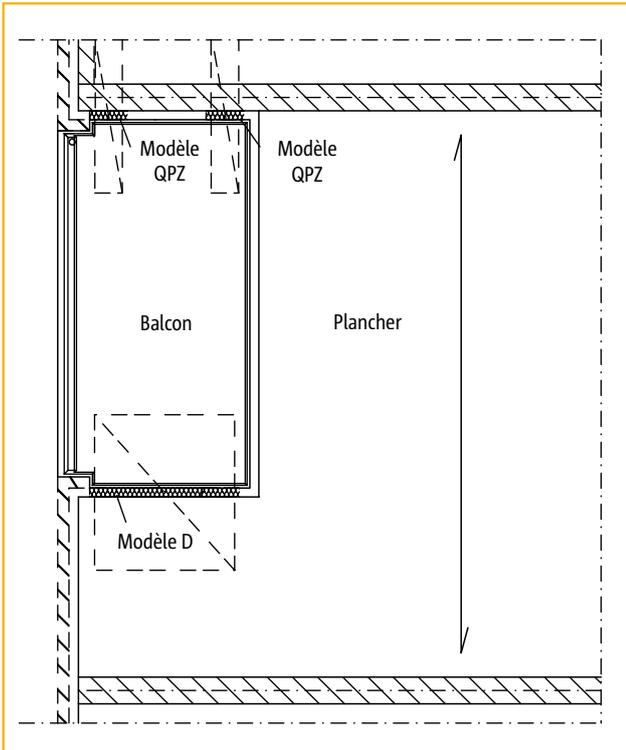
Balcon /loggia en tant que partie de la construction de plancher
